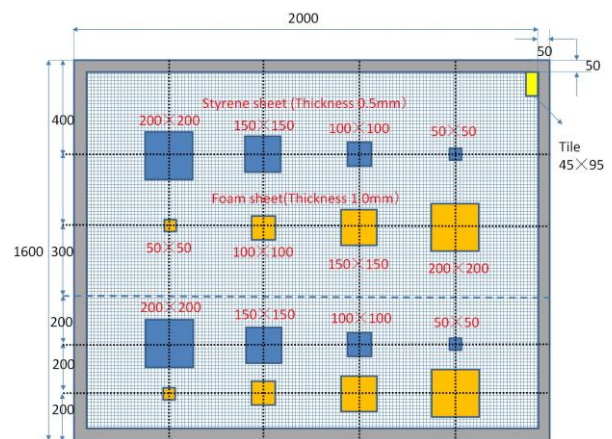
タイル張り外壁供試体の模擬欠陥シート配置図
